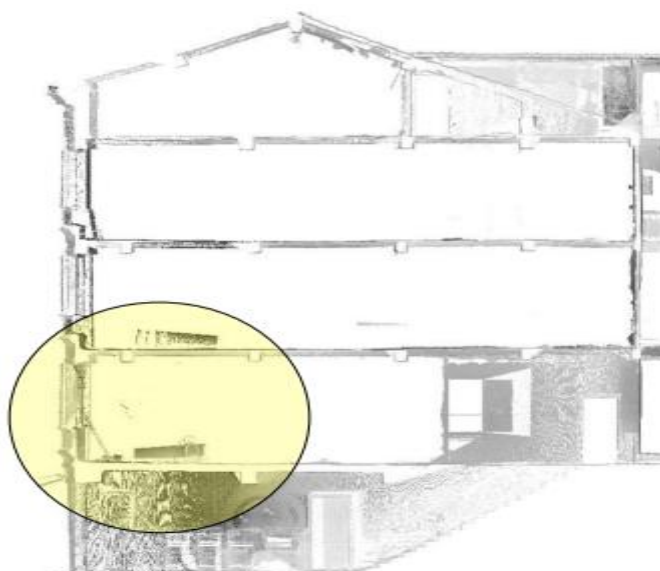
Orthophoto Intérieure Coupe dans Bâtiment
